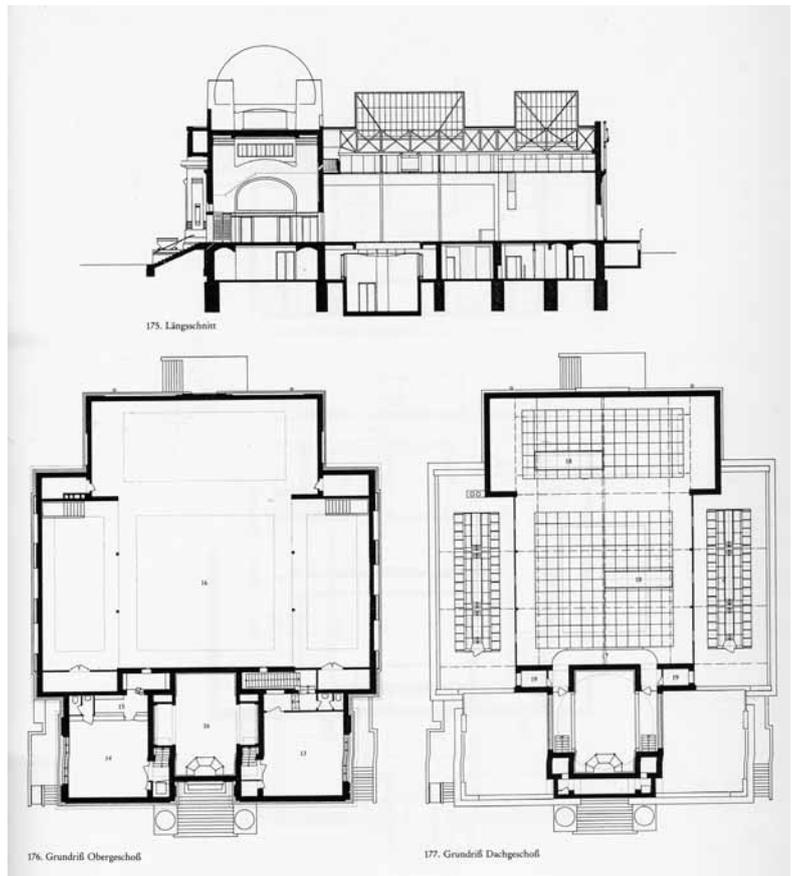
Plantas y secci3n del edificio de la Seccion Vienesa
